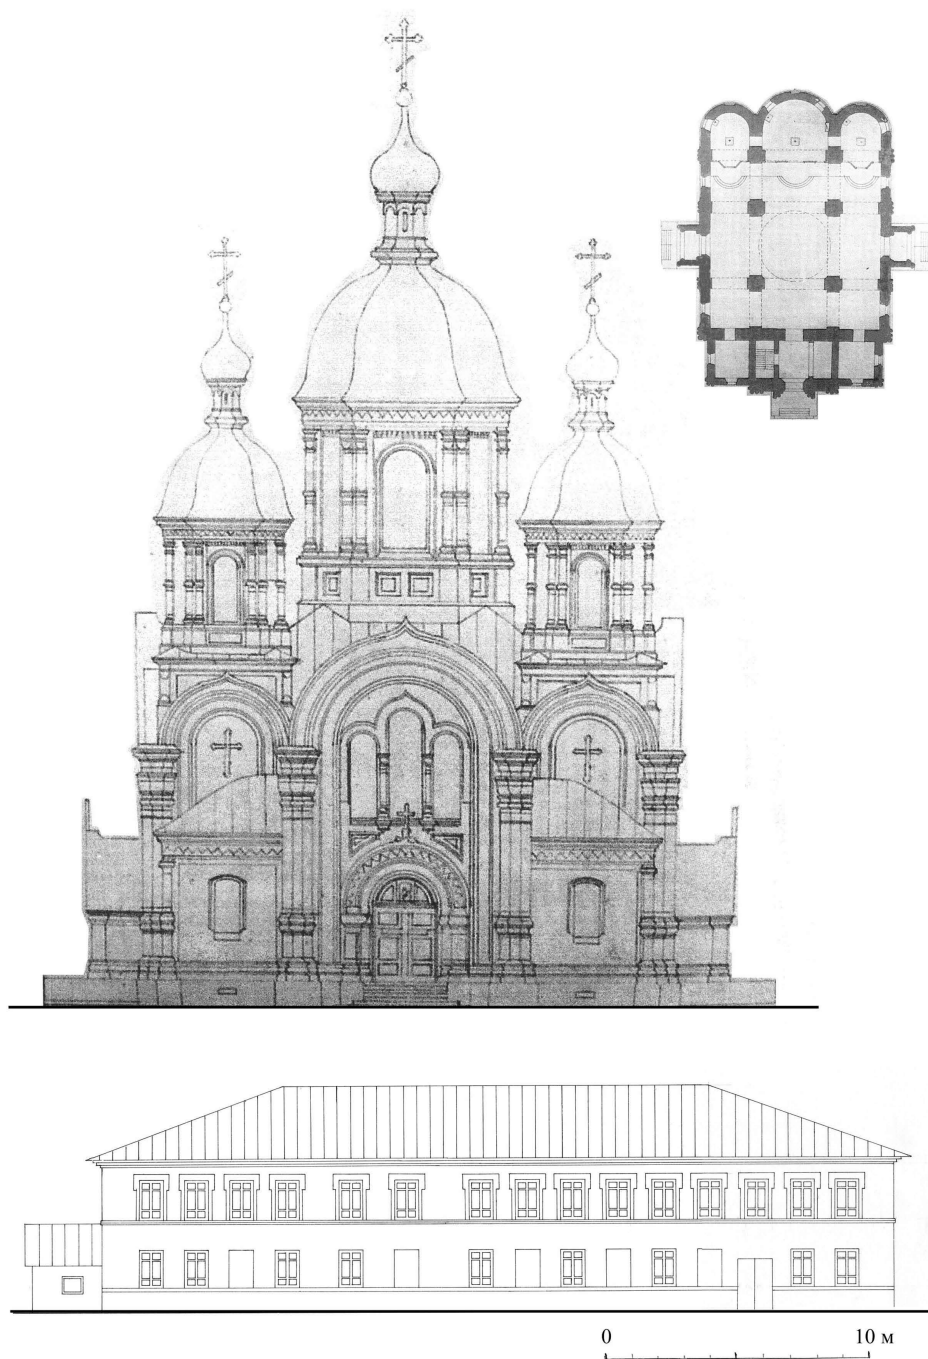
Троицкий собор. Проект 1864 г. Фасад, план (вверху).
